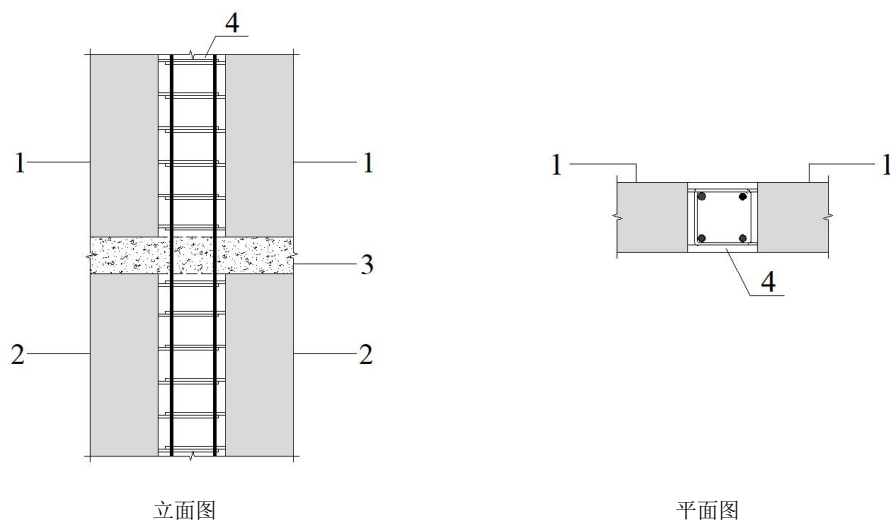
钢筋错位连接剪力墙竖向接缝后浇普通混凝土示意图
